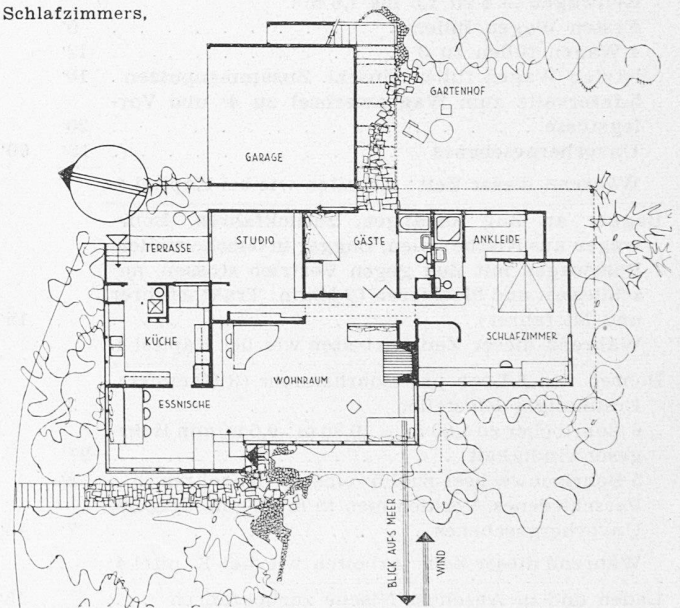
Haus Beckstrand, Grundriss 1:300
